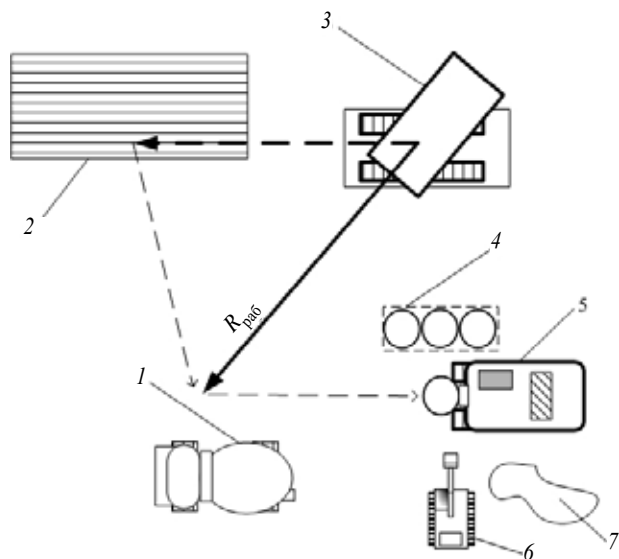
План-схема организации работ при устройстве буровых свай под защитой обсадных труб: 1 – автобетоновоз; 2 – арматурные каркасы; 3 – кран; 4 – участок складирования обсадных и бетонолитных труб; 5 – буровая установка; 6 – гидравлический экскаватор; 7 – отвал грунта
